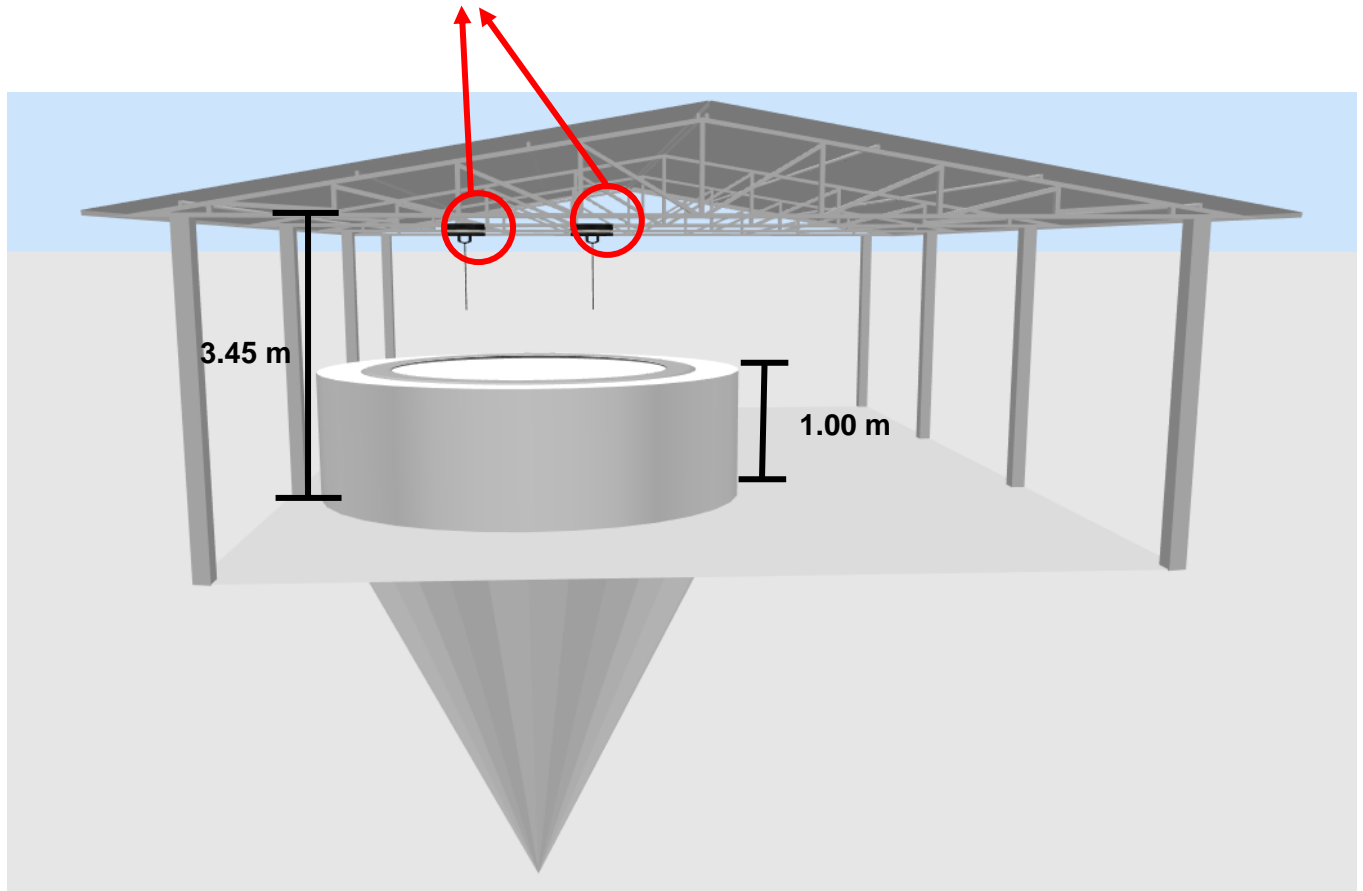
Propuesta de colocación del sistema de protección contra caídas. Vista frontal.
